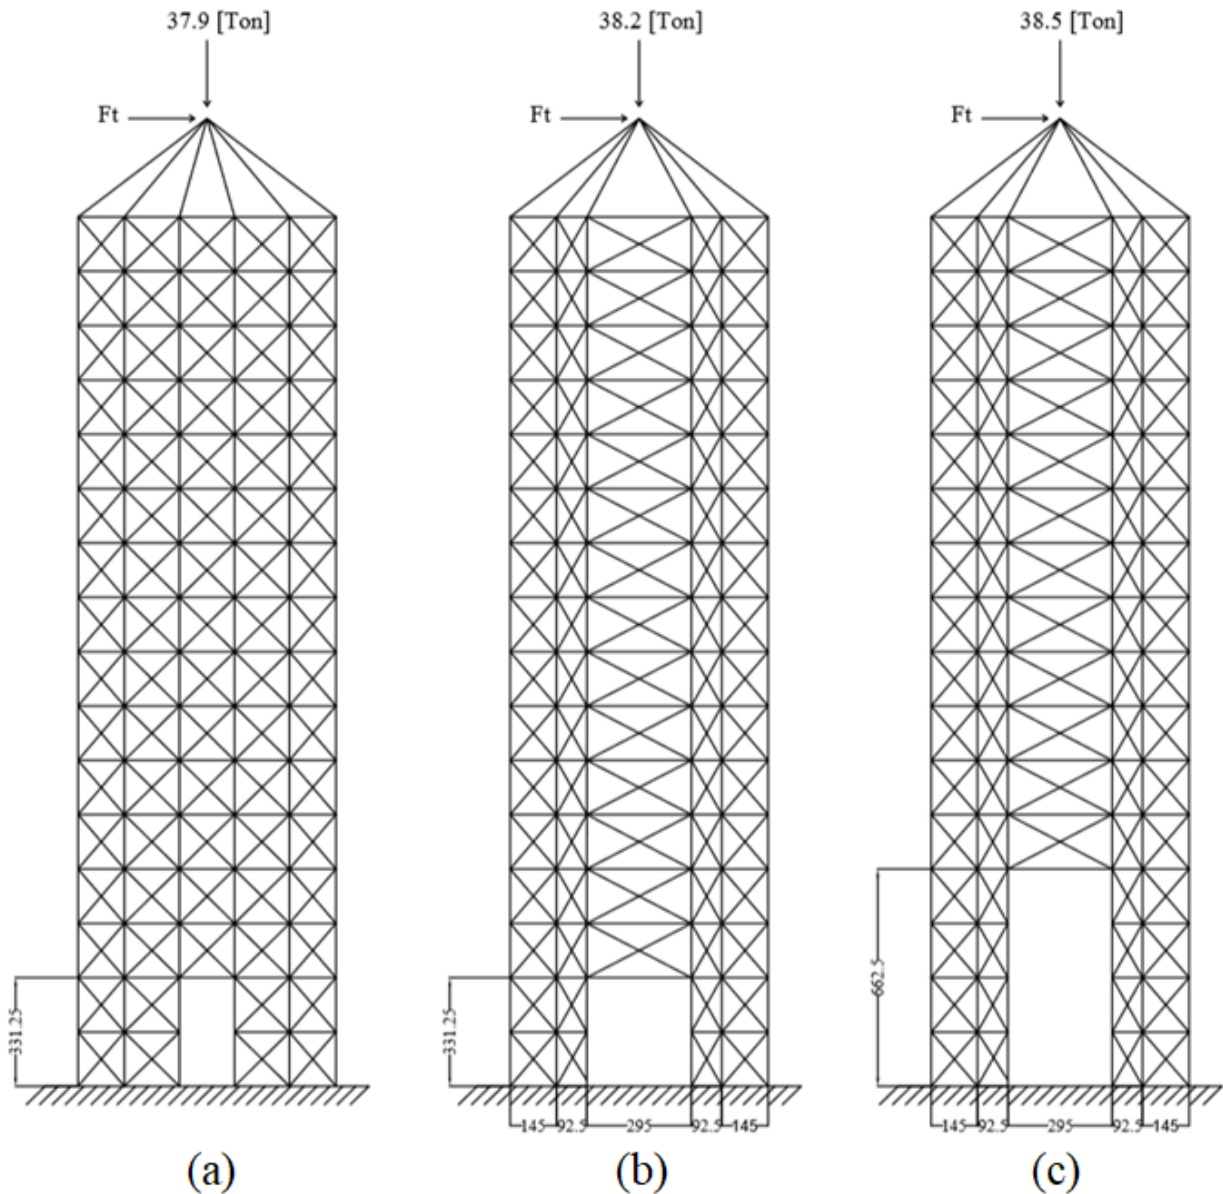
Esquema de los muros modelados. (a) Muro con abertura central 1, (b) Muro con abertura central 2 y (c) Muro con abertura central 3.
